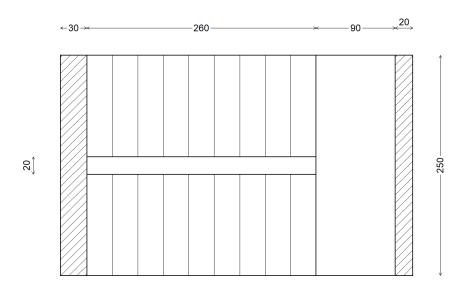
Vista acotada planta. Fuente: CYPE 2019
